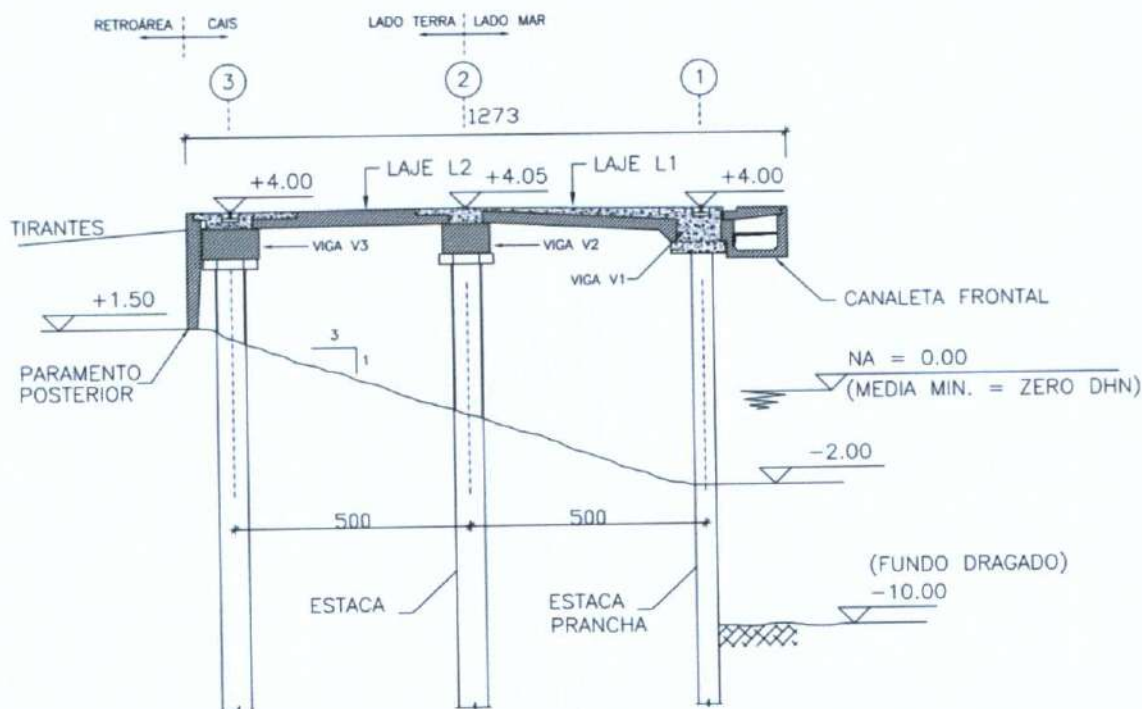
Seção transversal típica da estrutura – Fonte: Projeto Original
